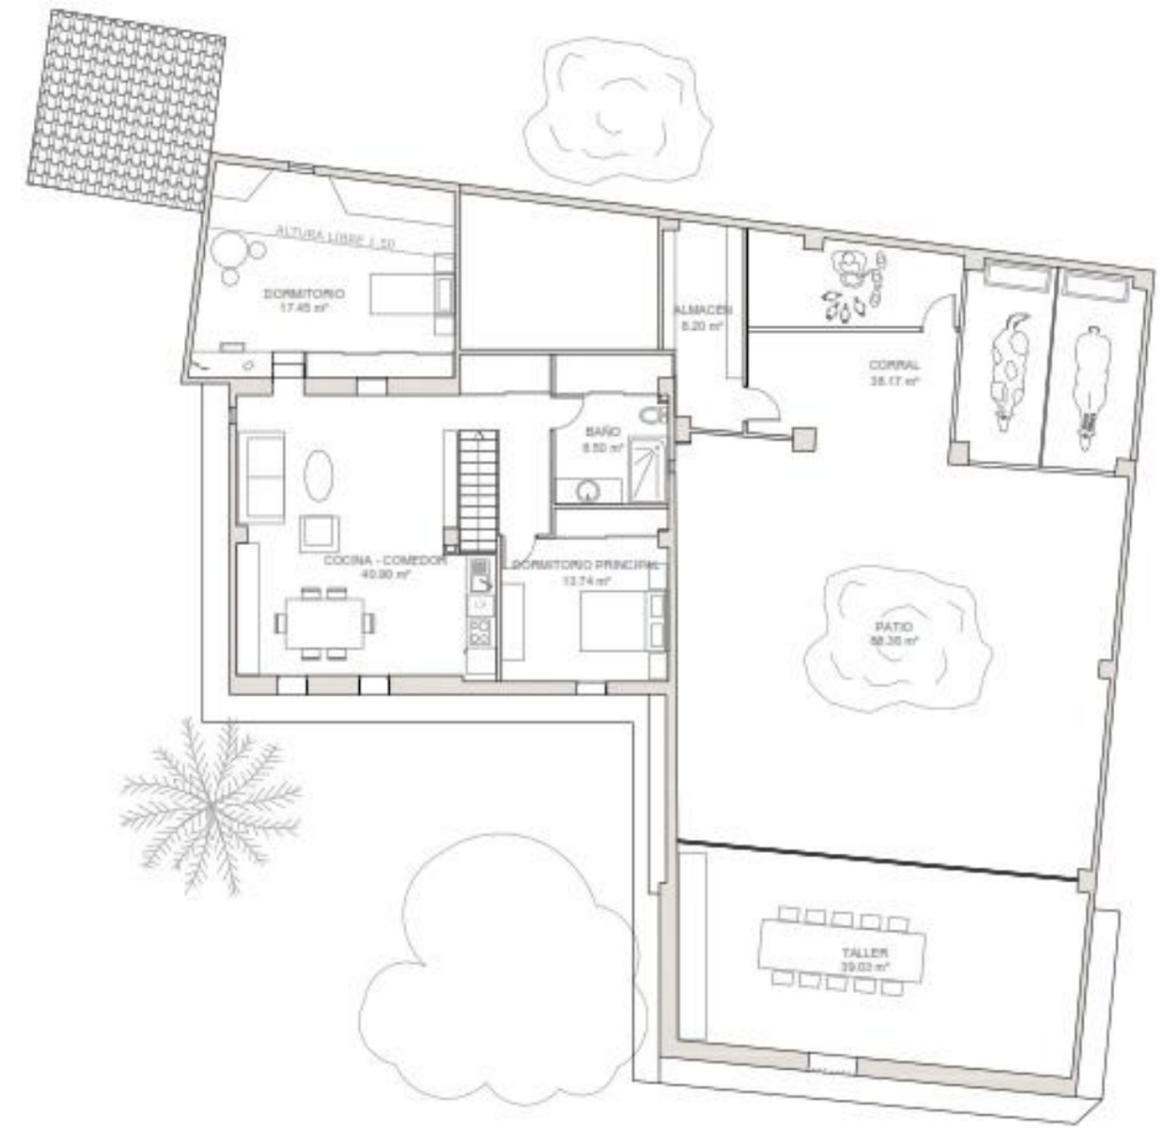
Nueva distribución propuesta. Planta primera. Fuente: propia autora
